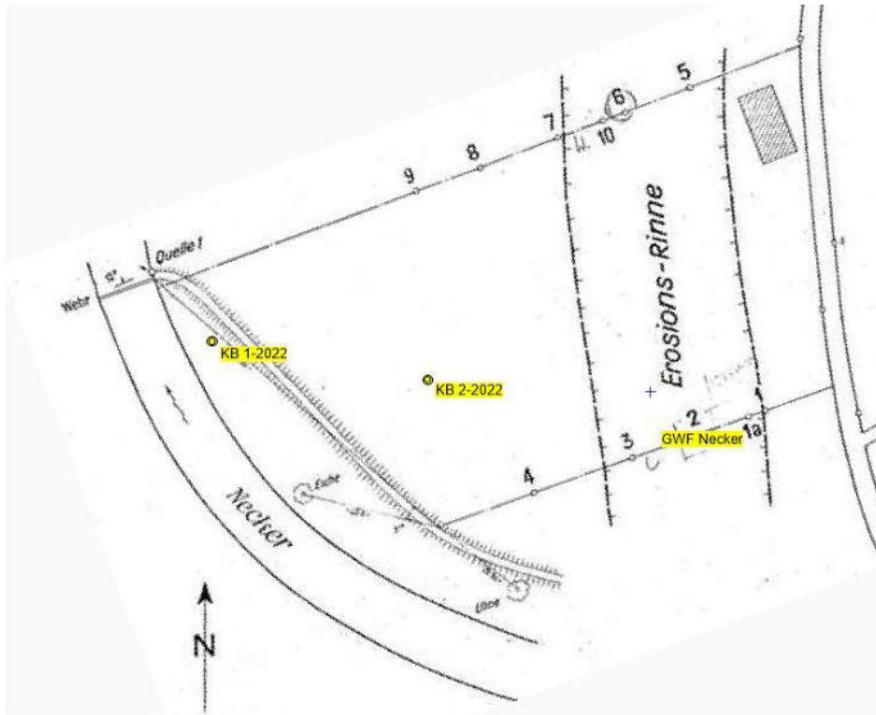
Situationsplan mit Lage der Rammsondierungen 1947 [4] und Lage der Bohrungen KB 1-2022 und 2-2022 und GWF Necker
